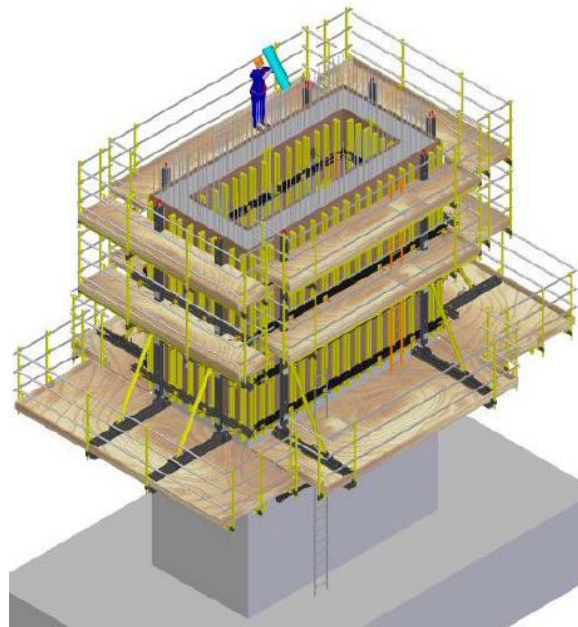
ac. Colado del elemento. Recuperado de: Ulma Construction, *Instrucción técnica de montaje*.
